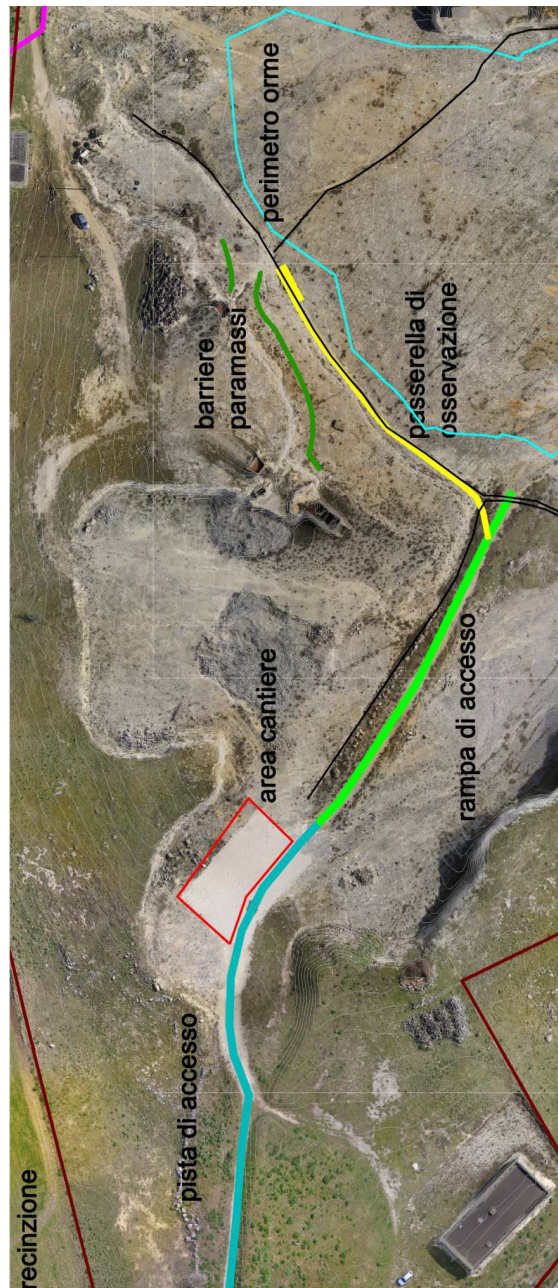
Ubicazione cantiere; pista e rampa di accesso, passerella di osservazione e barriere paramassi
